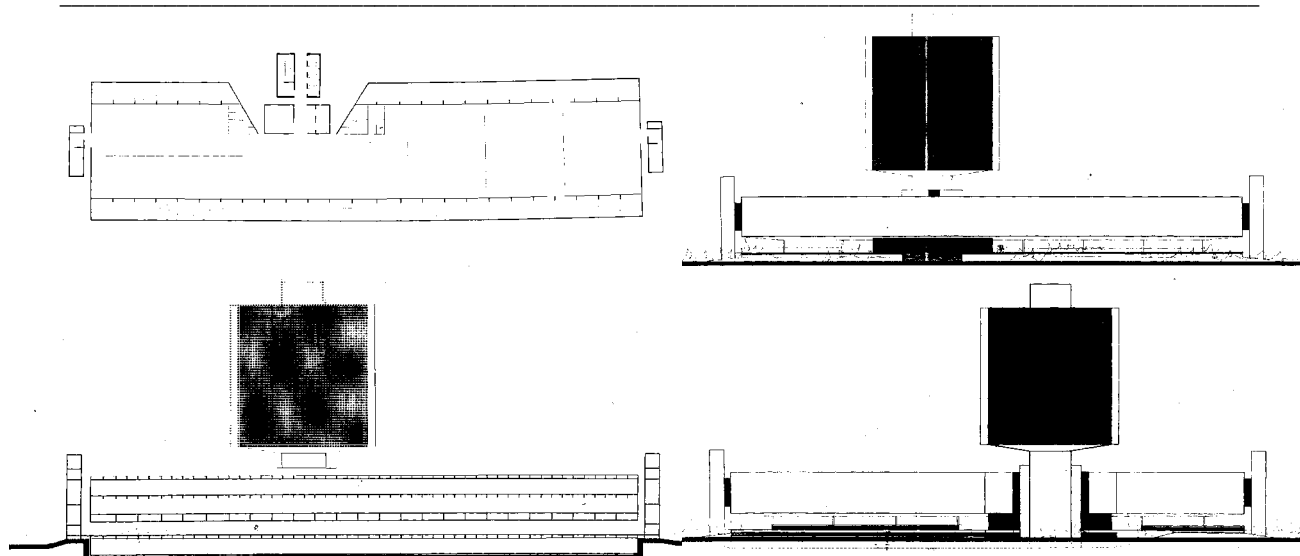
4º prêmio CREA SP; planta pavimento superior;
